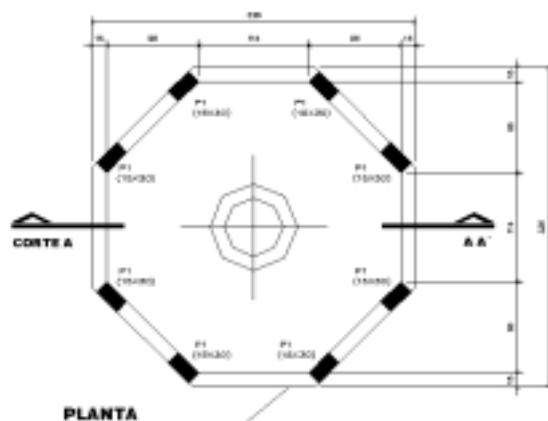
ESTRUTURA DA CAIXA PLANTA - COPEL
